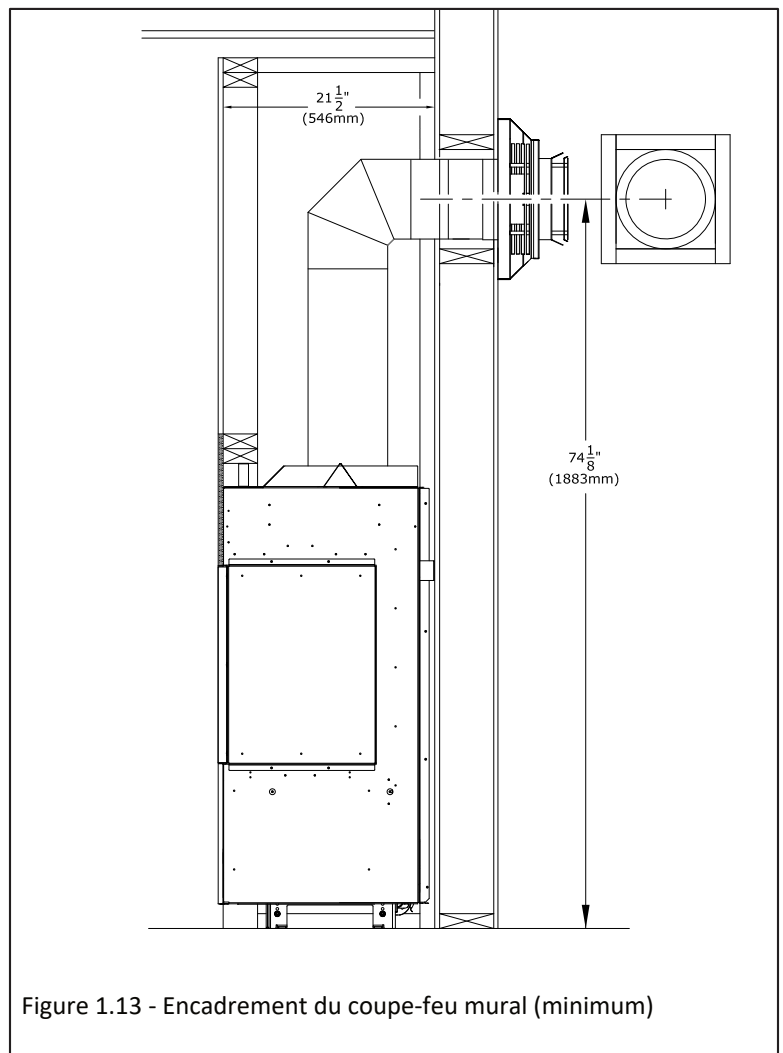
Encadrement du coupe-feu mural (minimum)
